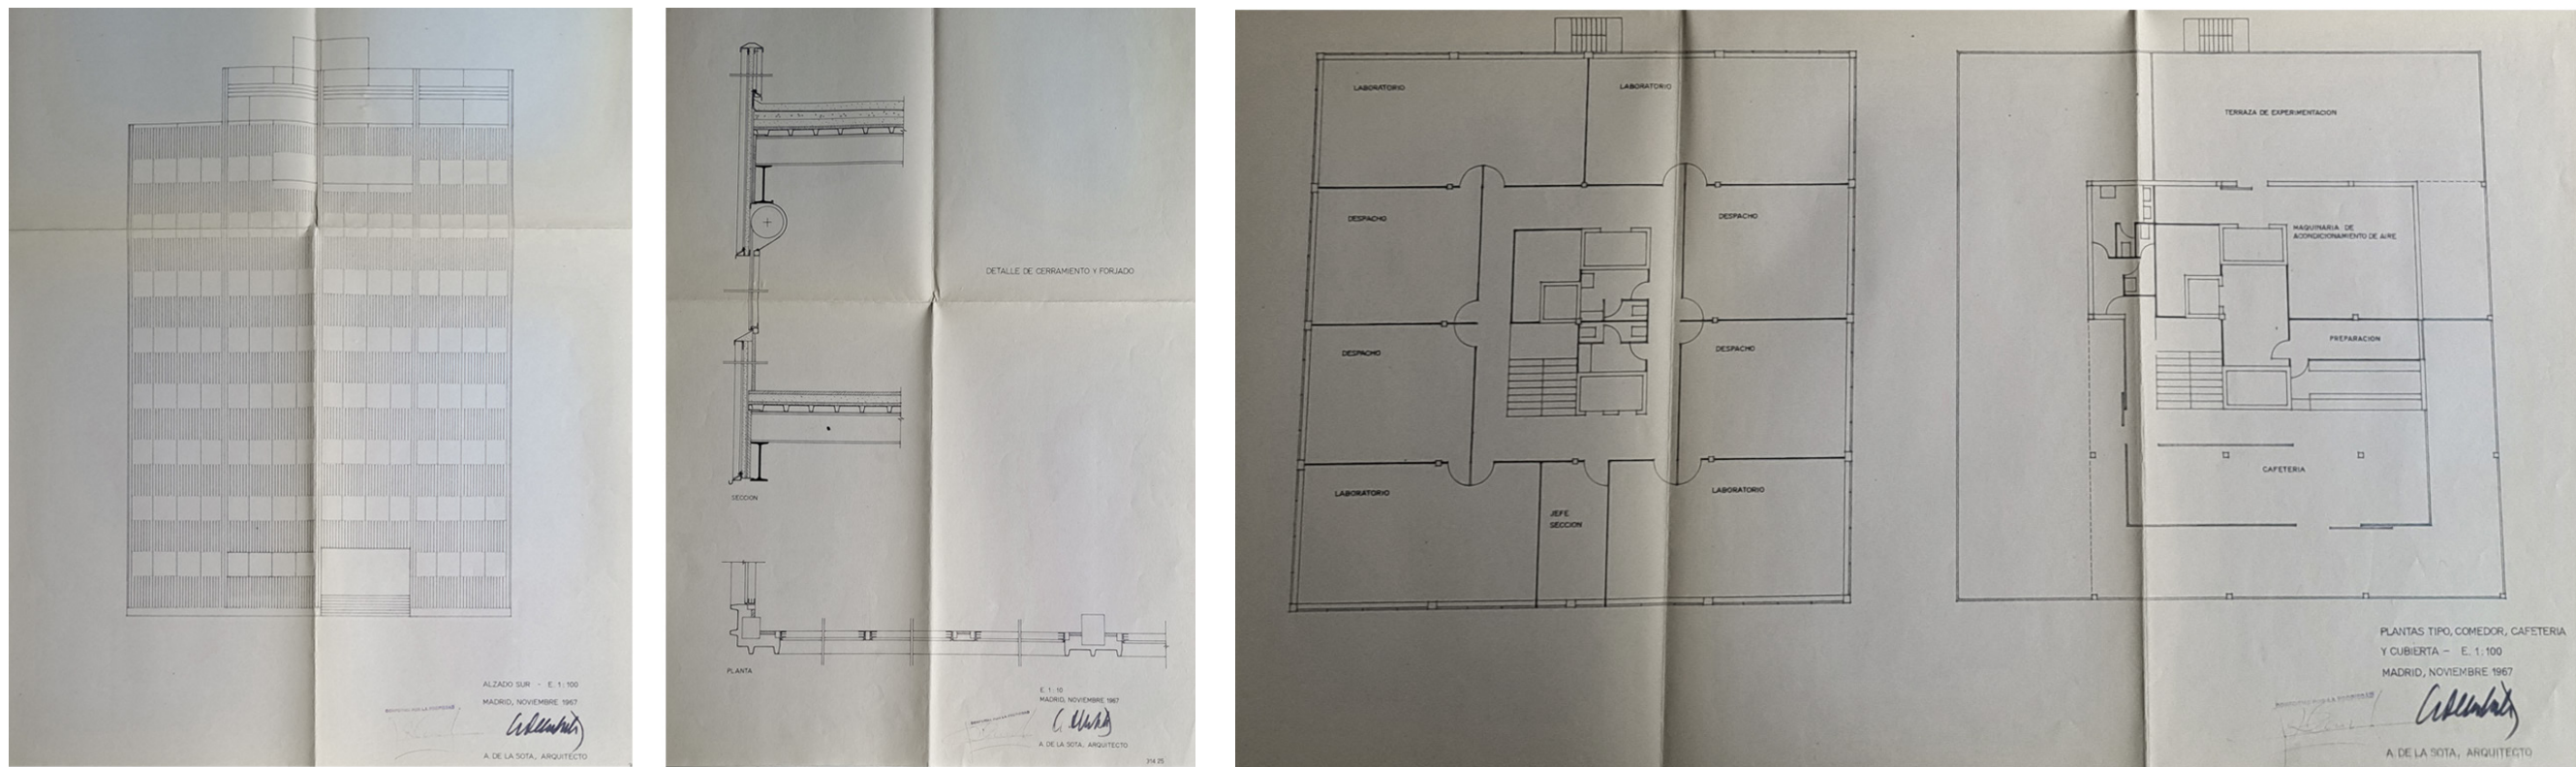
Alejandro de la Sota, Instituto de Electricidad y Automática, Madrid, 1968 (proyecto inédito). Alzado, detalle constructivo de fachada, y plantas tipo y de cubierta.
